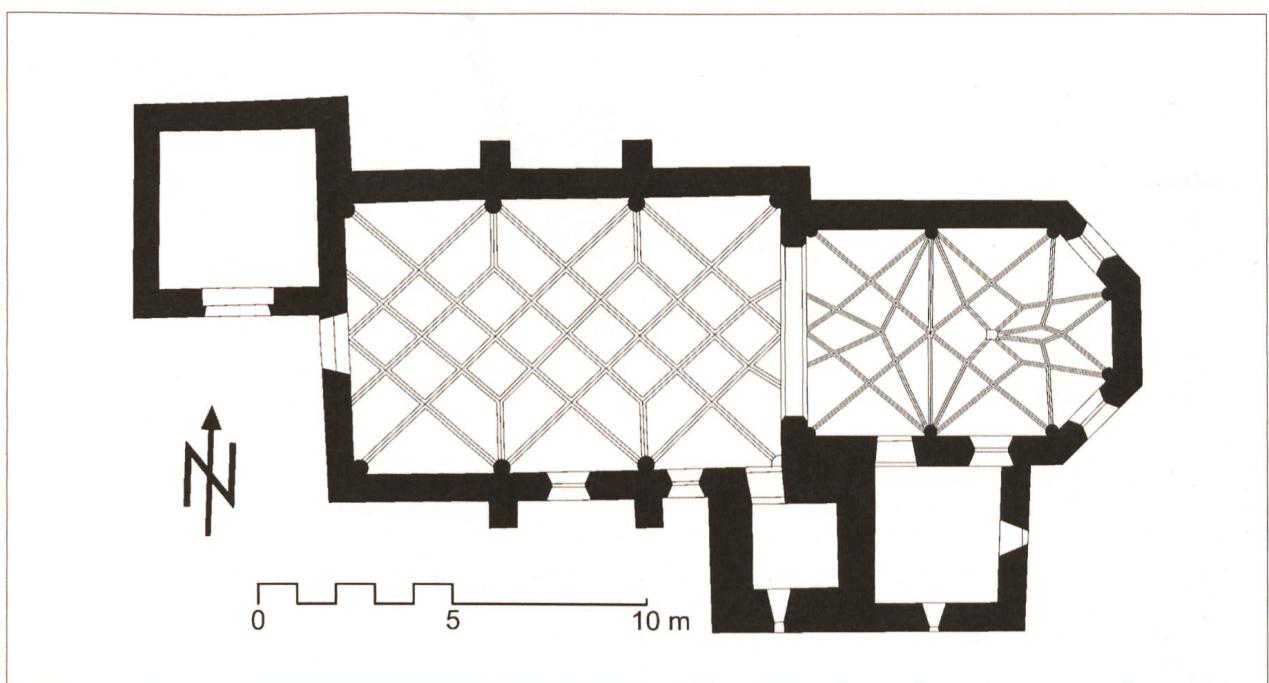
Grundriss der Alten Pfarrkirche St. Maria in Lantsch/Lenz aus Handaufmassen und tachymetrischen Messungen erstellt.
